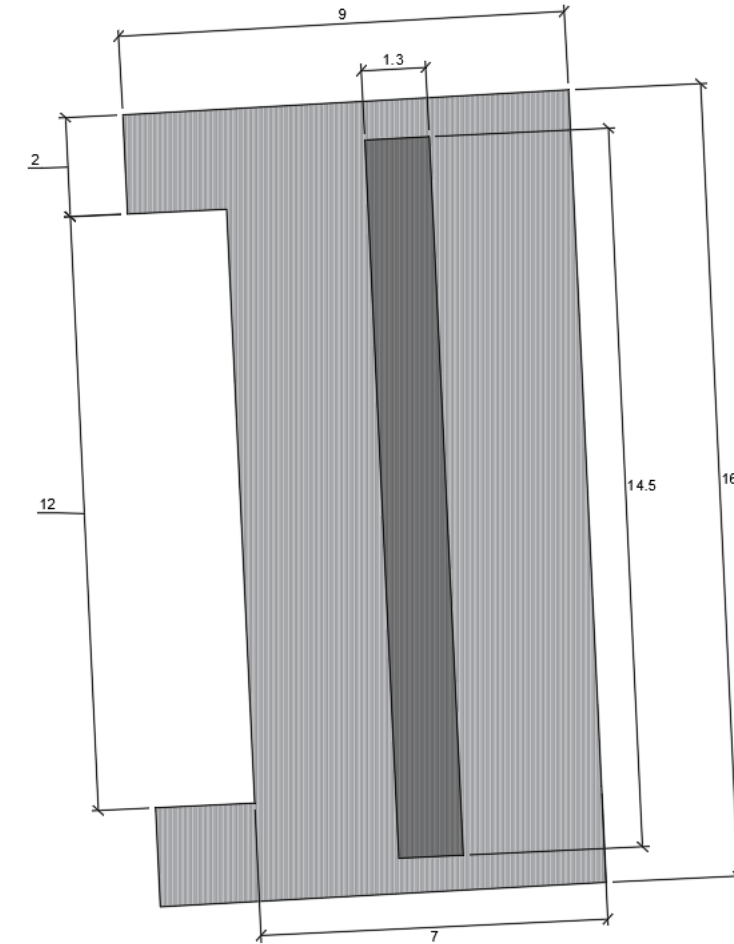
Vista en planta de la cimentación del Estribo Izquierdo
